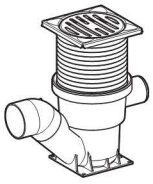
Einbau mit Einbauständer, Verlängerungsaufsatz und Flansch (Dichtebene oben)
